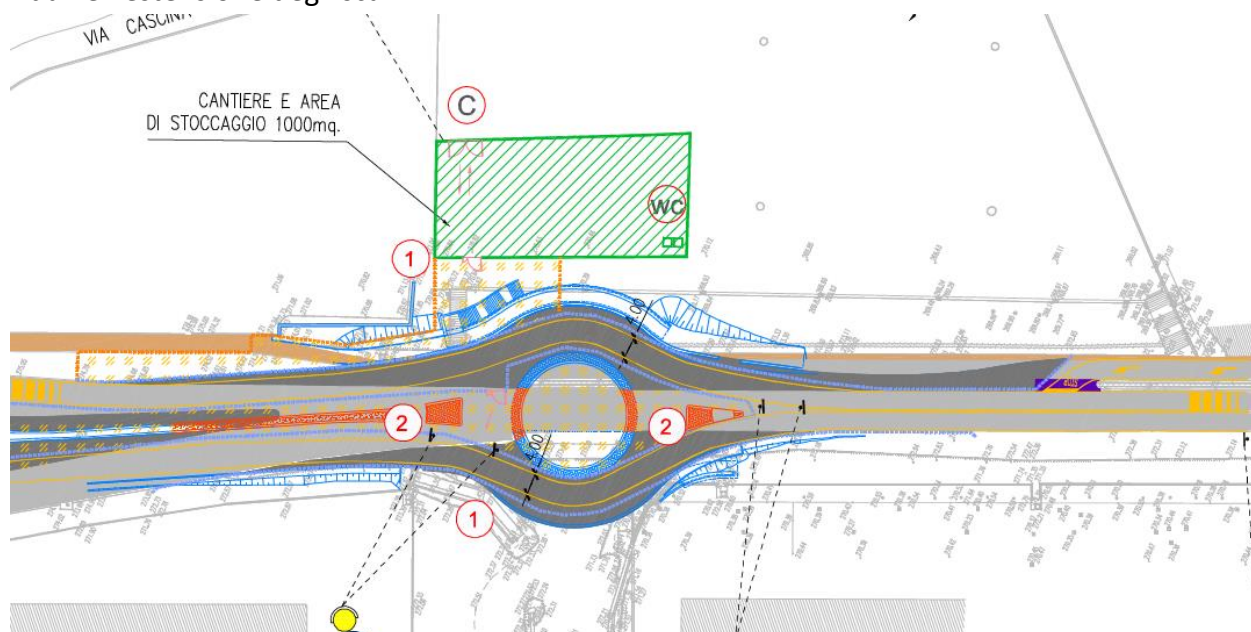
Stralcio planimetria fasi realizzative – corpo centrale
